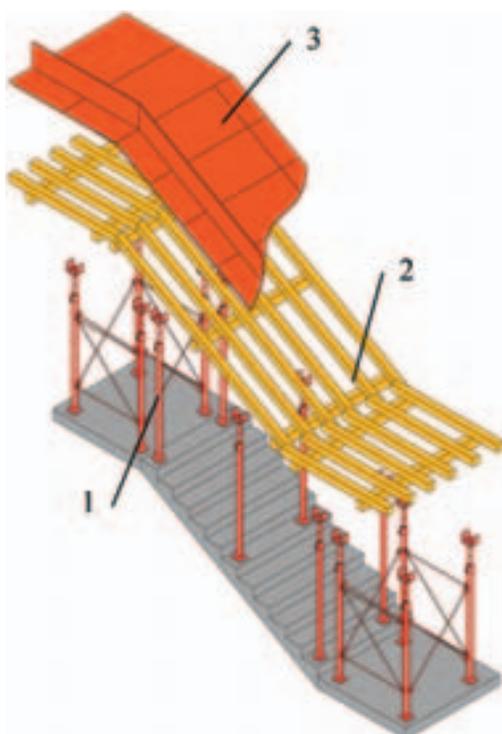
Схема опалубки монолитных лестниц: 1 — опорная система; 2 — система опорных балок; 3 — палуба из водостойкой фанеры
